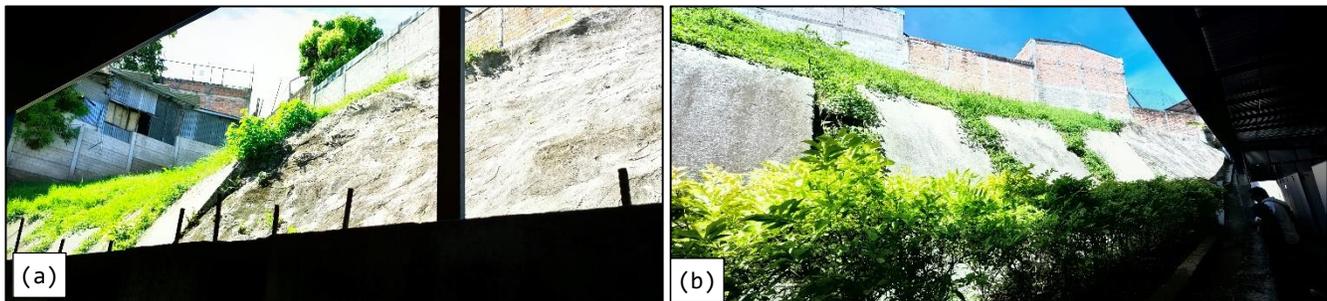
Vista general de ubicación de talud en colindancia con a las casas #3, #4, #5 y #6, entre el Colegio Bautista Belén y el Polígono “U”.
